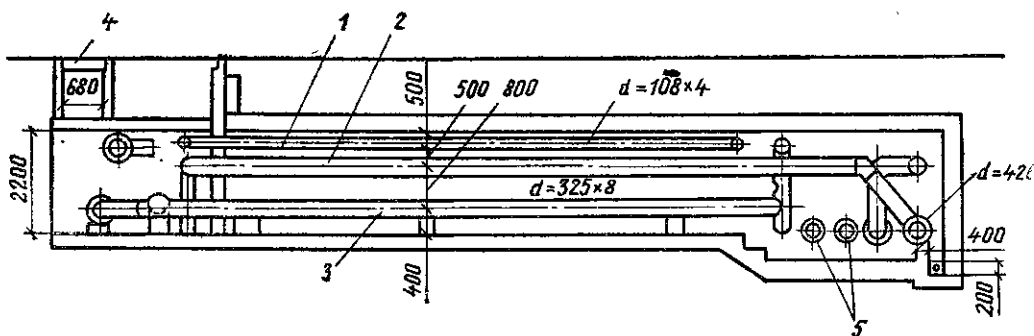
Схема укладки в туннеле водопроводных и технологических трубопроводов
